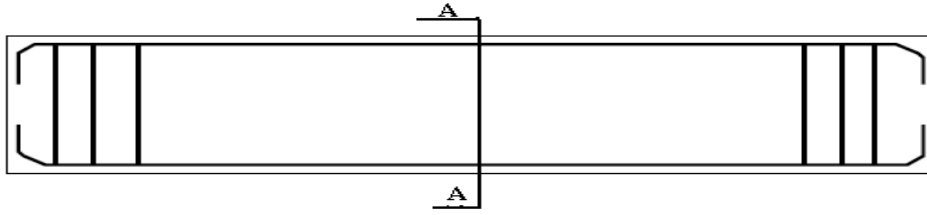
La coupe longitudinale de ferrailage pour les trois poutres (1, 8 et LMT).
